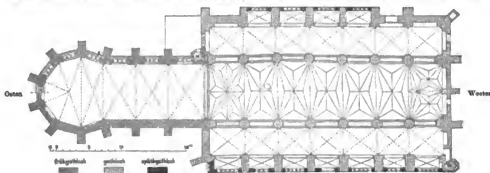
Grundriss der St. Johanneskirche in Stettin.
